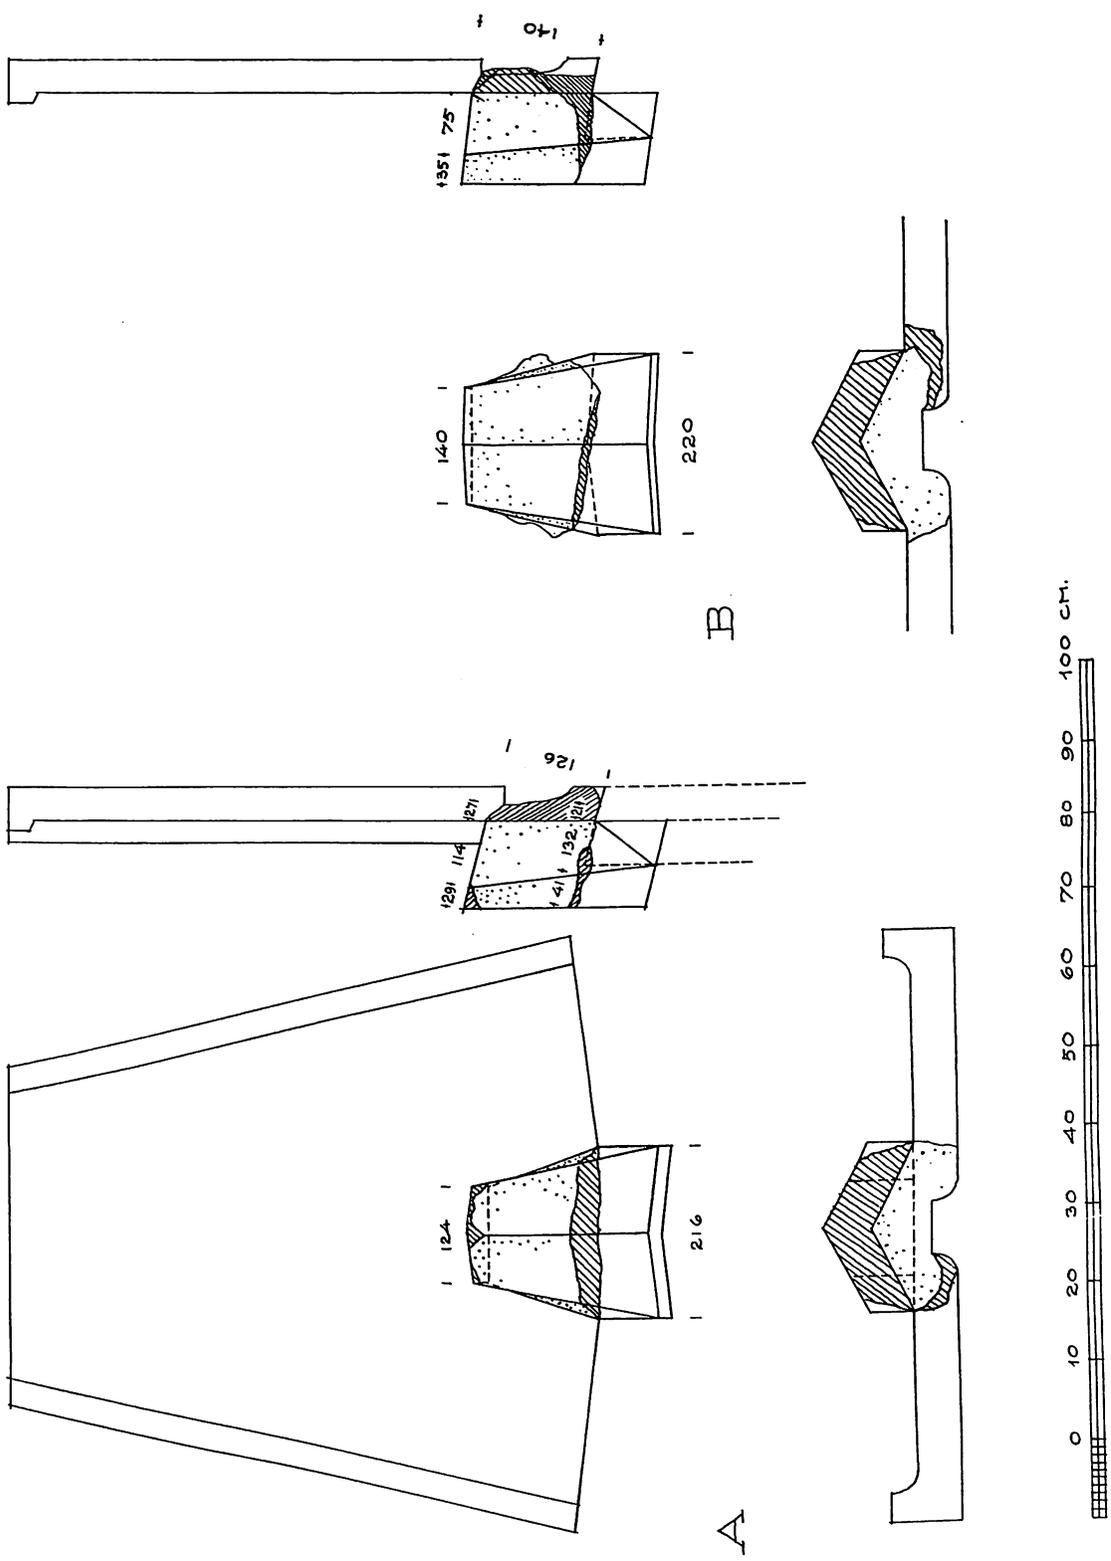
Épidaure. Tholos. Tuiles plates avec couvre-joint d'arrêt, type II.
